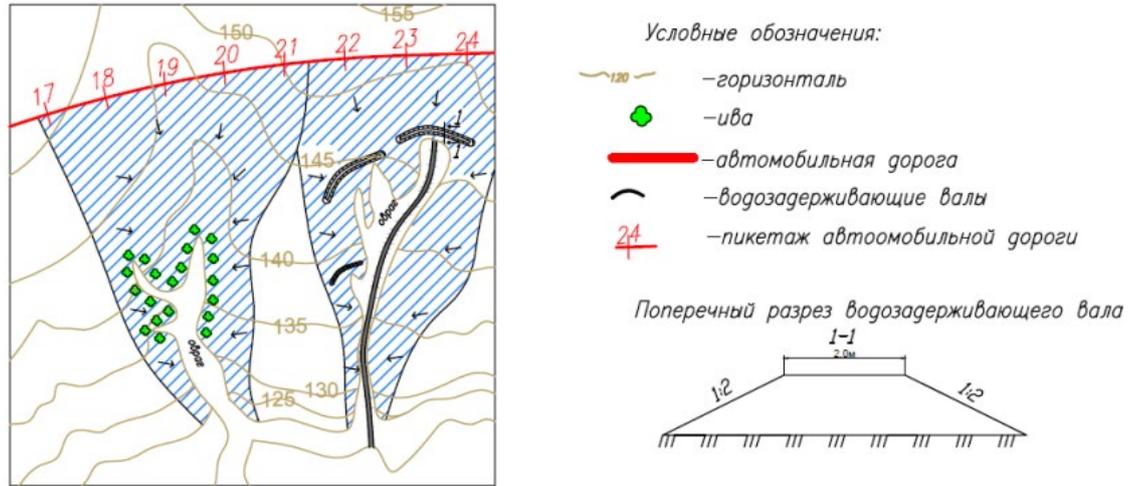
Схема расположения посадки ивы водозадерживающего вала и бетонного быстротока
